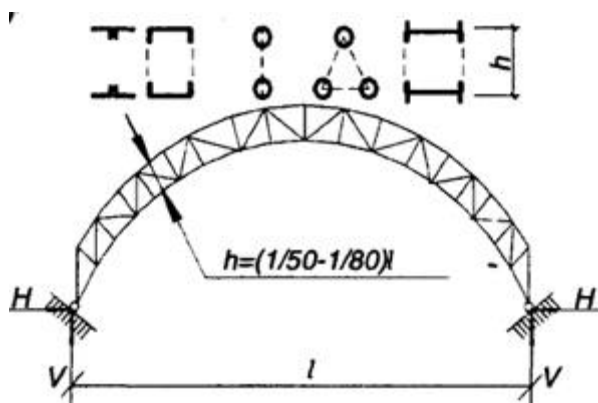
Конструктивная схема и типы сечений сквозной двухшарнирной арки
